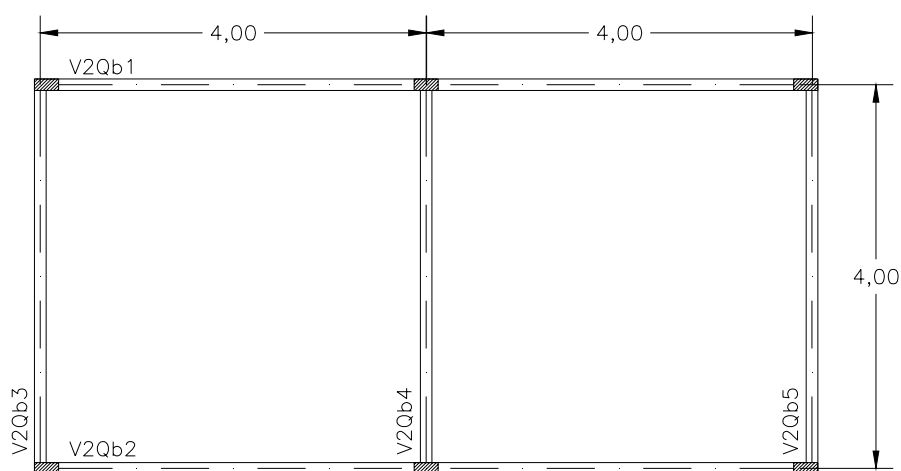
Pavimentos (P2Q) com dois painéis quadrados (4m X 4m) apoiados em 6 pilares
